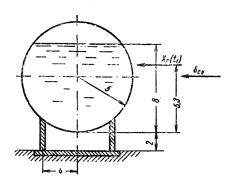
Схема сферического резервуара, установленного на железобетонном «стакане»
